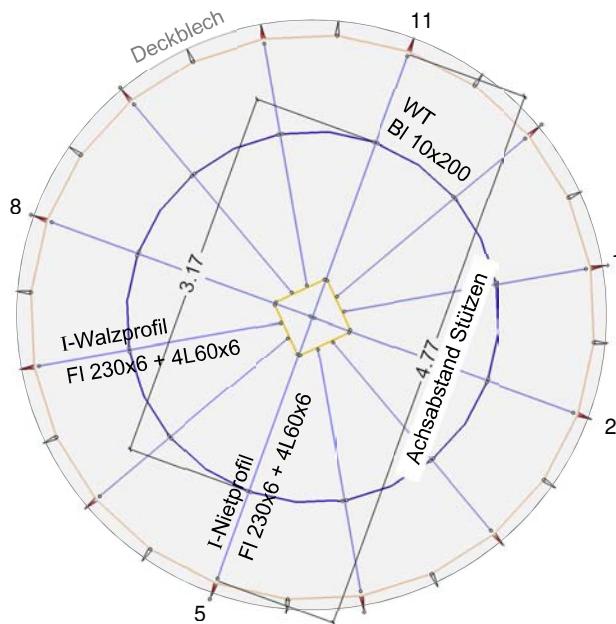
Grundriss Decke über Dienstzimmer mit Querschnittsbezeichnungen
